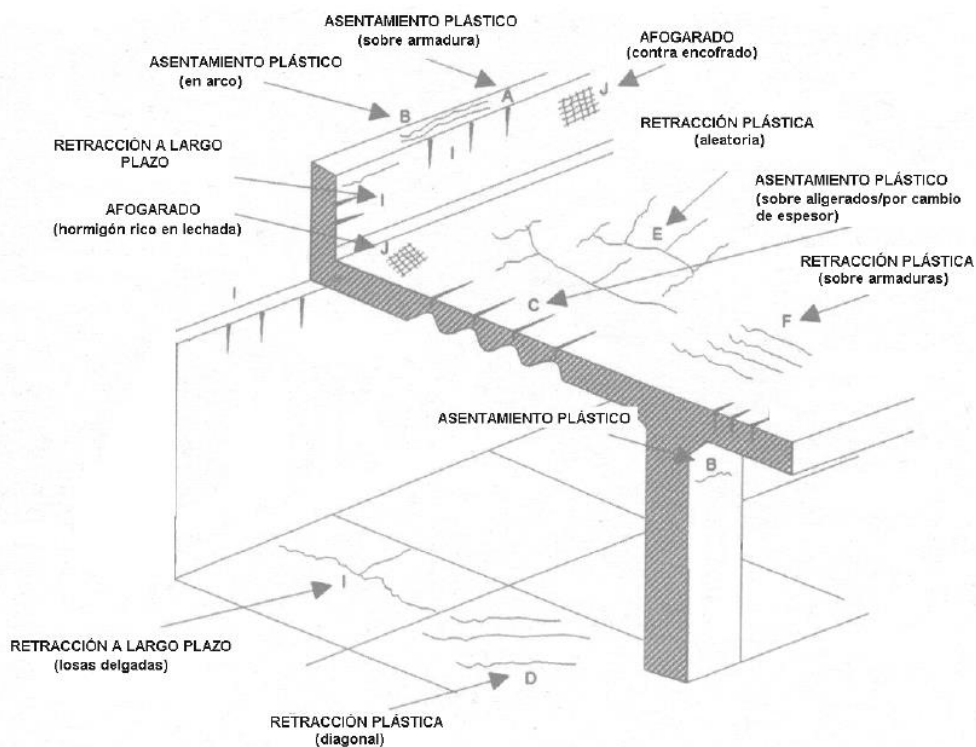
Tipos de fisuras por retracción y asentamiento plástico [8].
